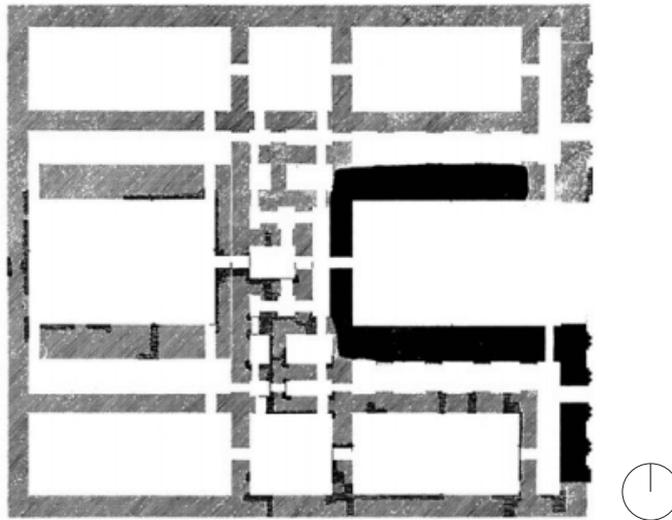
Grundriss von Taq-e Kesra in Ktesiphon.
